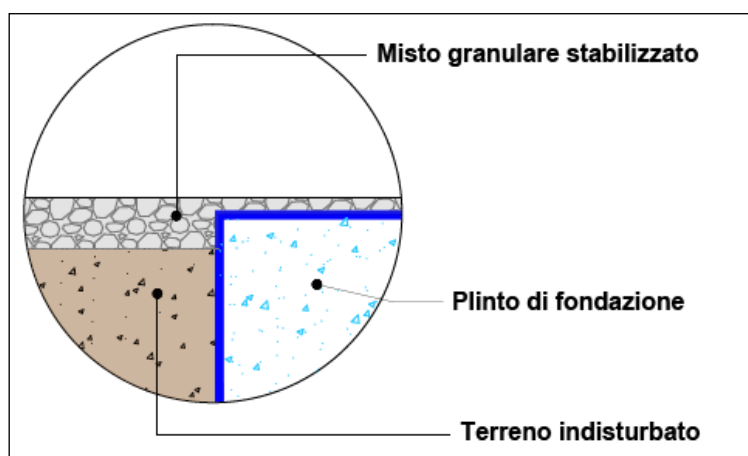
Particolare pavimentazione piazzola tipo in fase di esecuzione lavori
